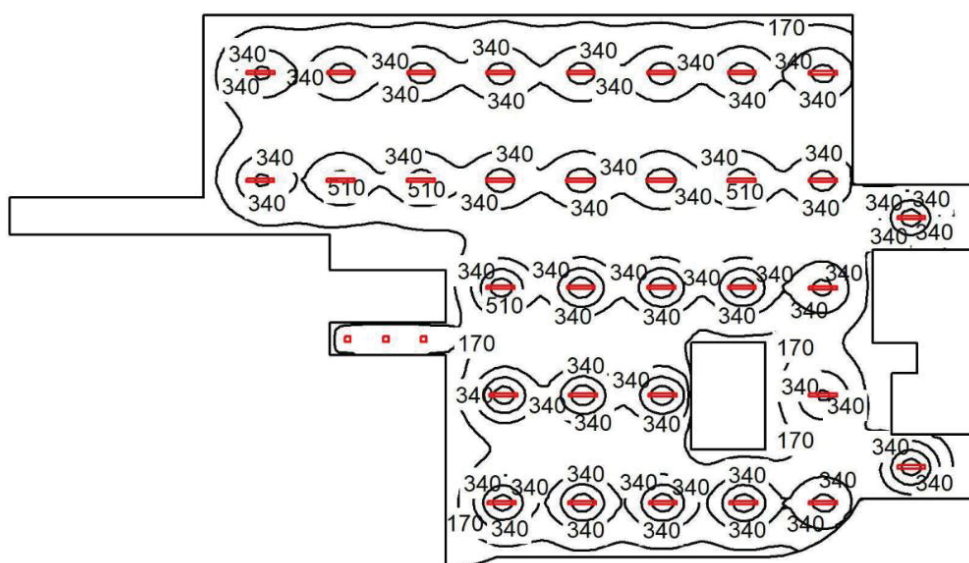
Distribuição luminosa artificial para a GARAGEM no térreo e primeiro pavimento, conforme projeto lumínico existente.
